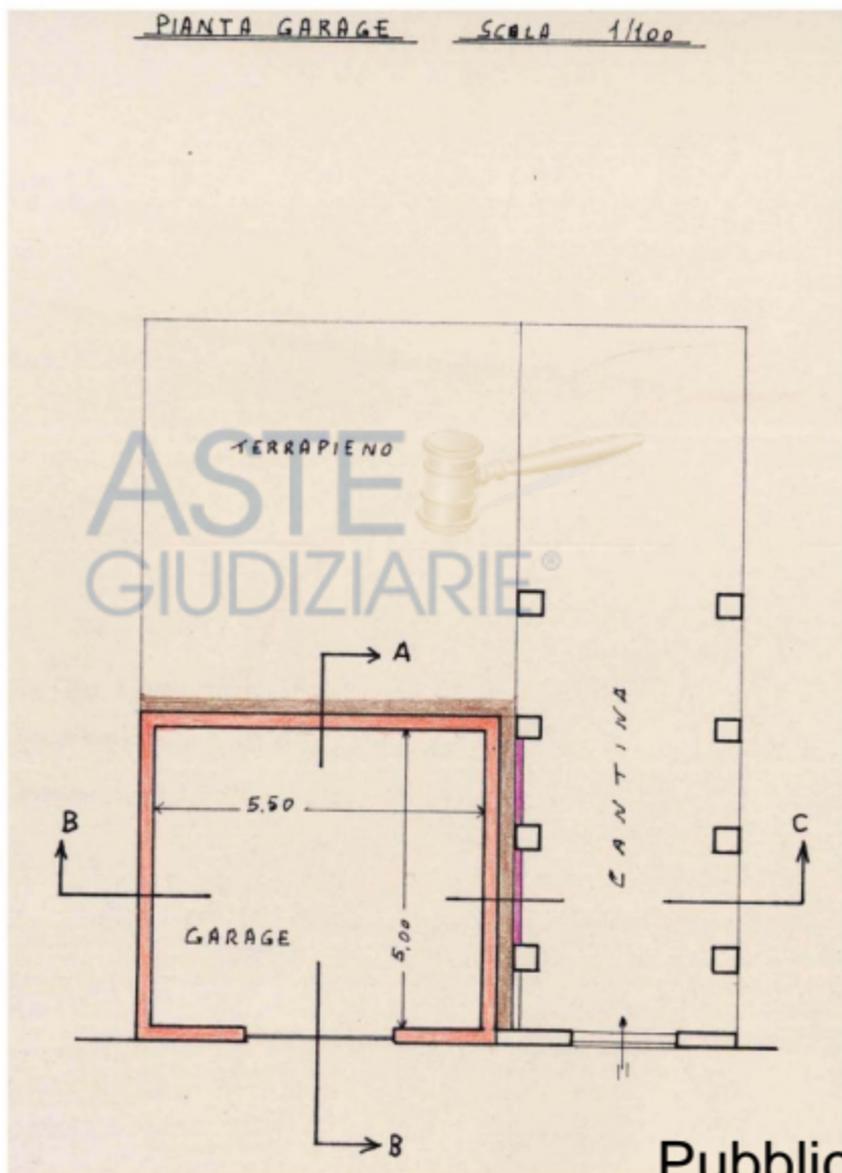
planimetria estratta dalla tavola grafica allegata all'Aut. Fed. n. 610/1989 • scala indicativa
